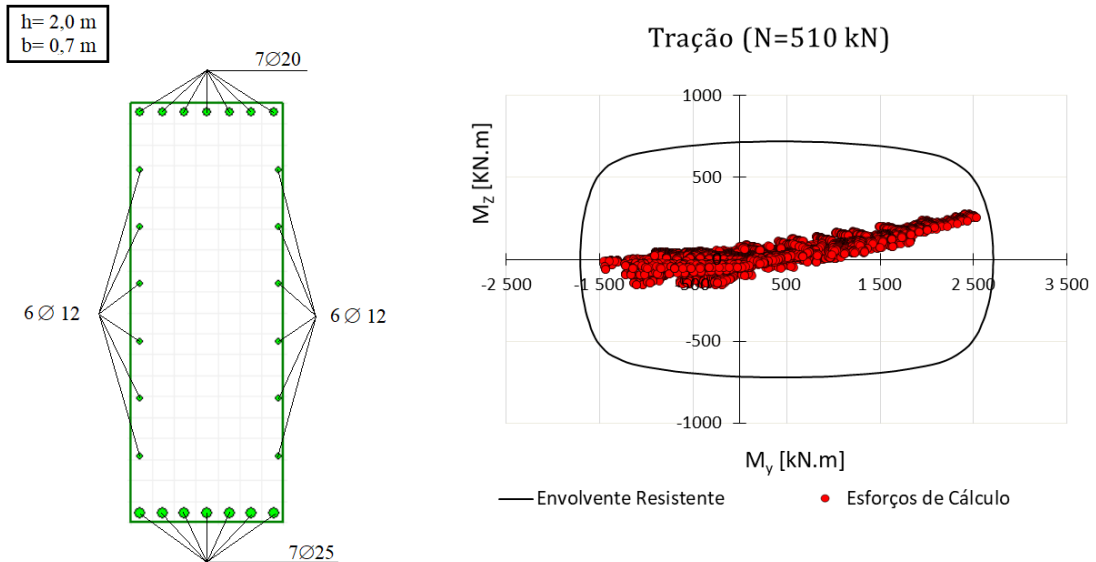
Armaduras longitudinais na viga V3F e ábaco de dimensionamento.
